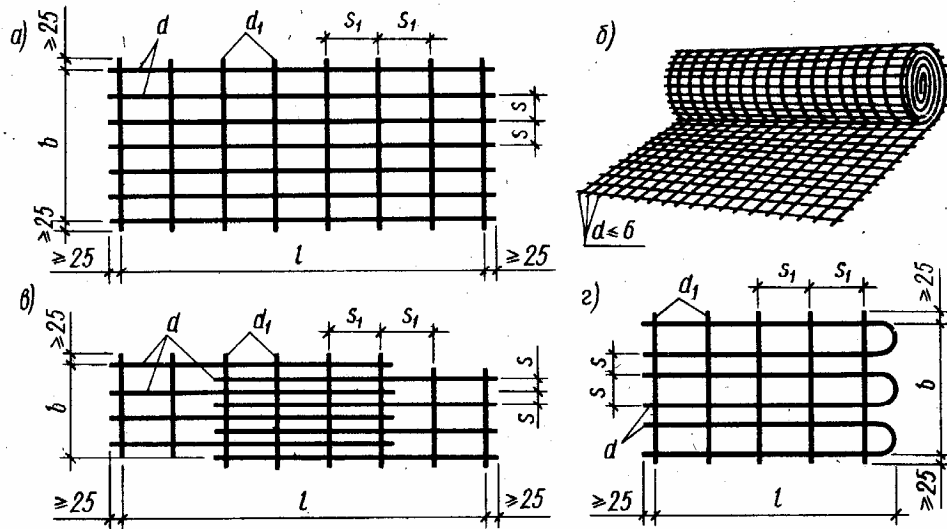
Сварные сетки: а- плоские; б – рулонные
